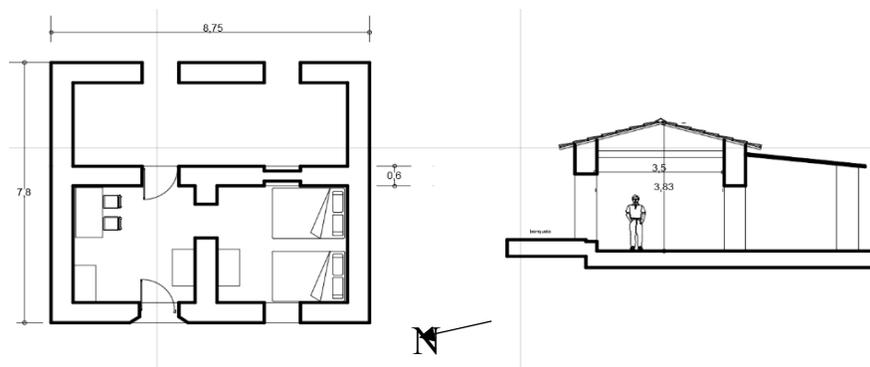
Planta arquitectónica y sección de vivienda de adobe y teja. Suchitlán.
